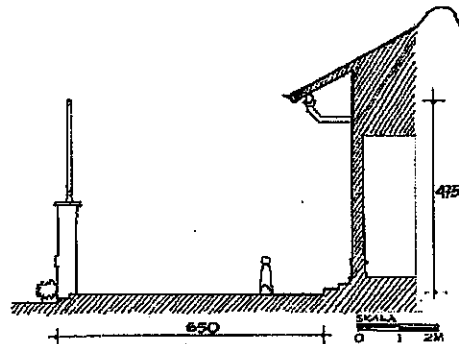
Fasade Bangunan Area Kelenteng Hoo Hok Bio
